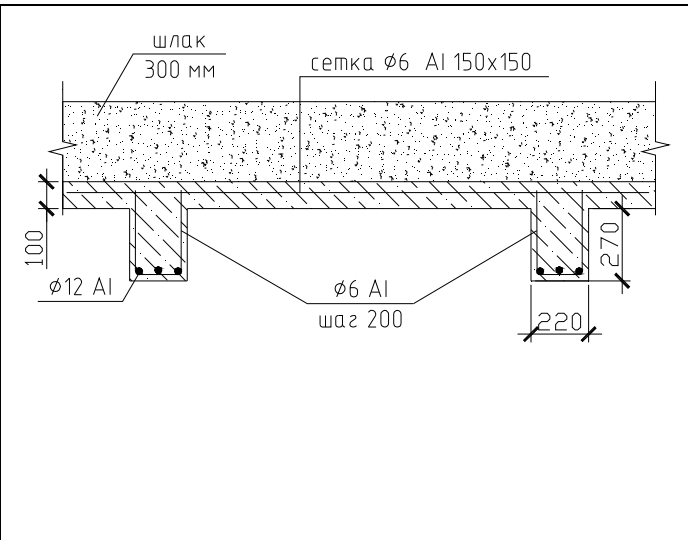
Второстепенная балка ж/б перекрытия над пятым этажом в осях «3–8/А–В»
